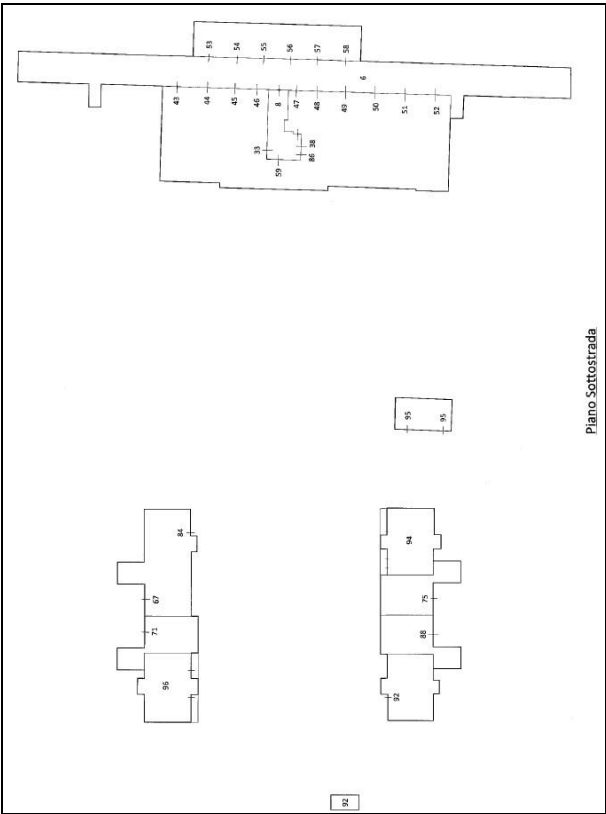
Planimetria subalterni piano sottostrada ([Allegato N.4](#))
